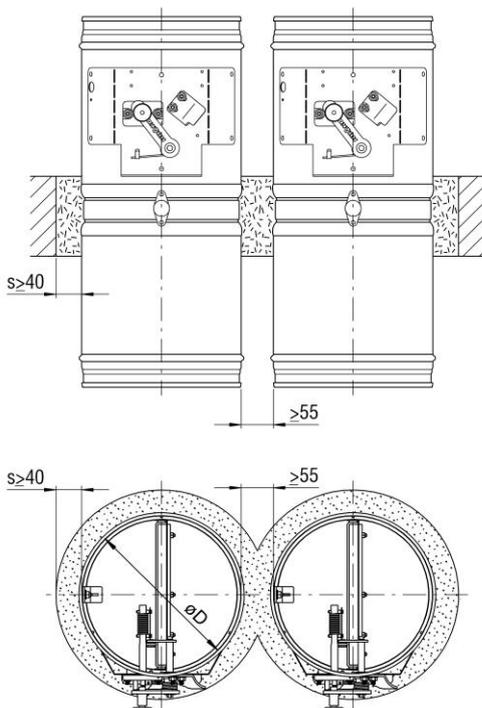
Nasseinbau verringertem Abstand, massive Decken (Aussparung rund, wie gezeichnet bzw. eckig)
